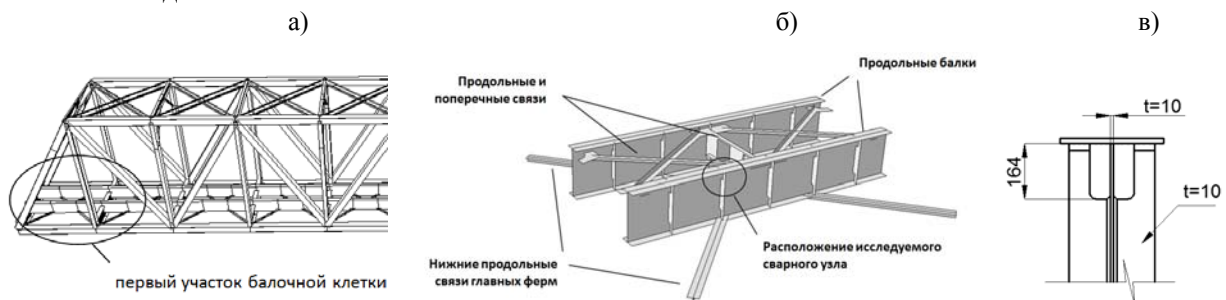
Розташування розгляданого ділянку балочної клітки решітчастого пролетного строення (а), розташування досліджуваного сварного вузла (б) і його основні розміри (в)
